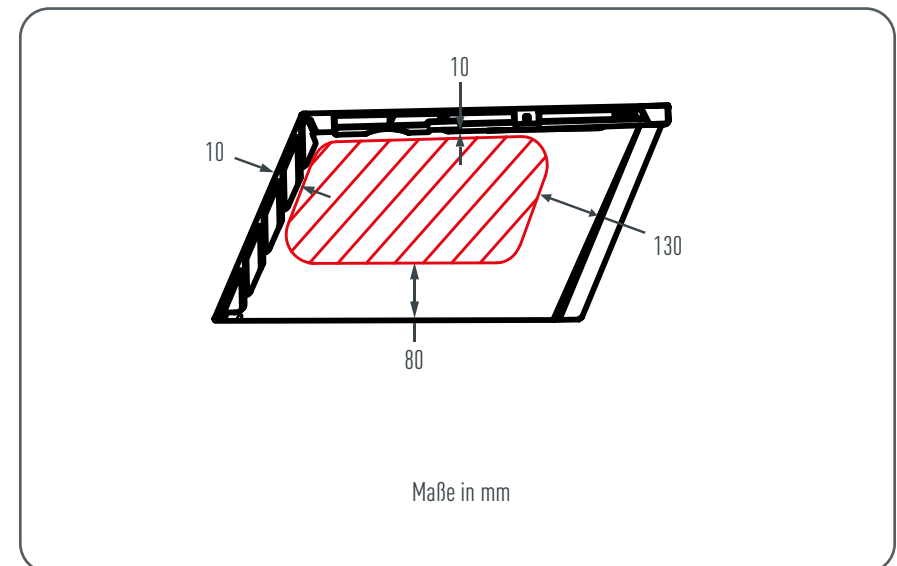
Dachschindel DS.19 – Montagebereich
